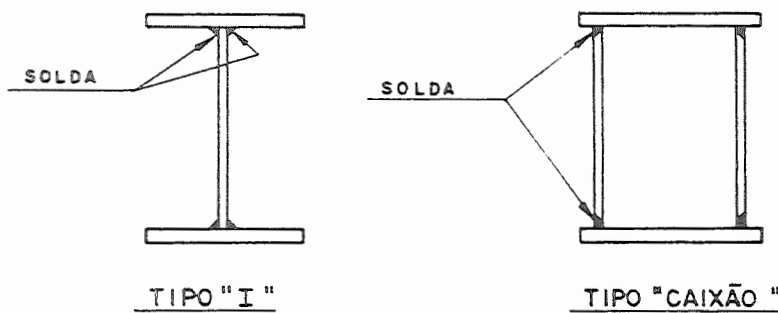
EXEMPLOS DE PERFIS SOLDADOS
